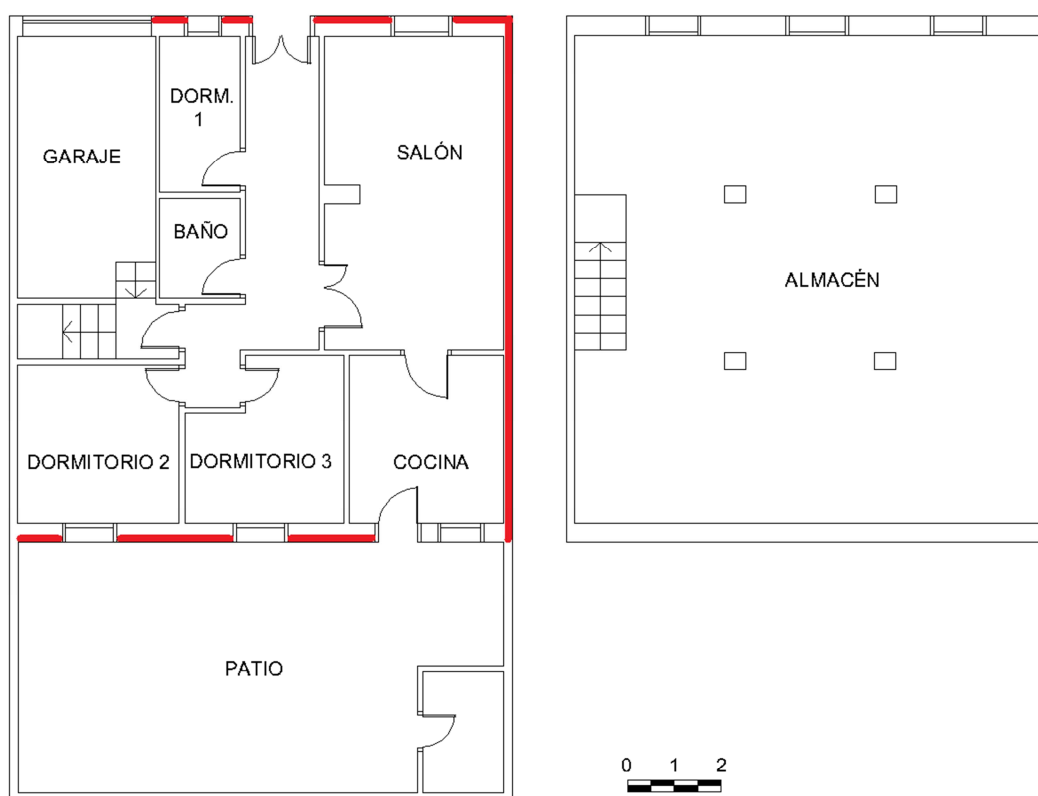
Plano con ubicación del deterioro por capilaridad. Fuente propia.
